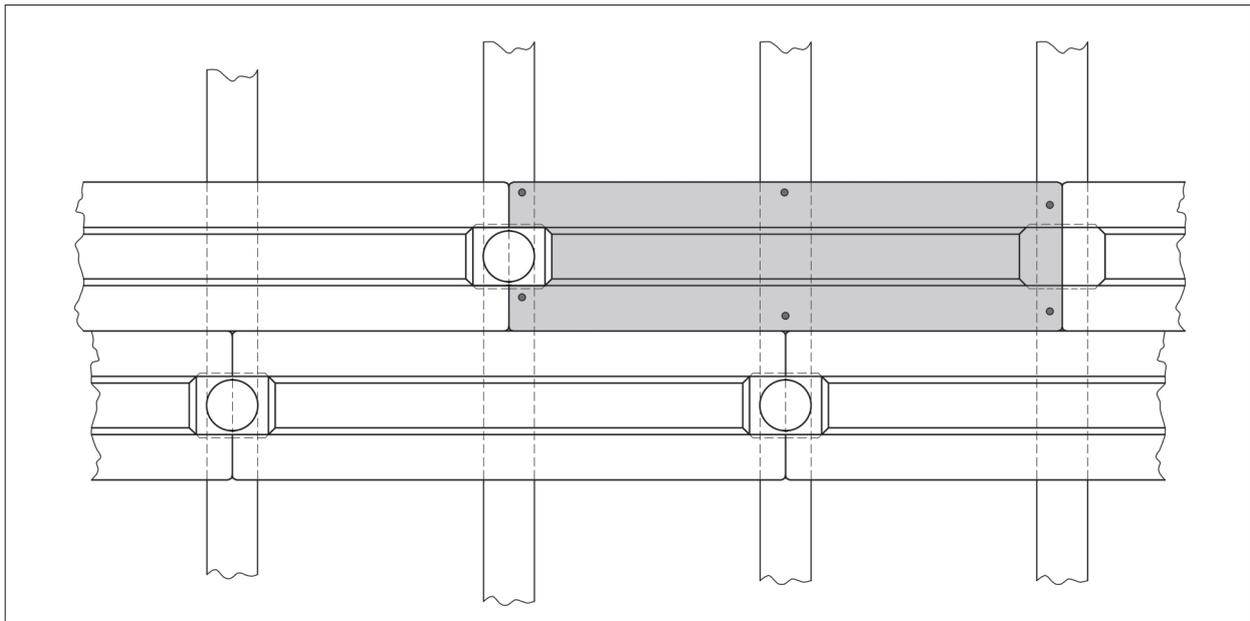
Rekonstruktionsvorschlag: Vertäfelungsfläche aus gesteckten, mit einer Unterkonstruktion vernagelten Paneelen und Ornamentträgern. – ohne M.
